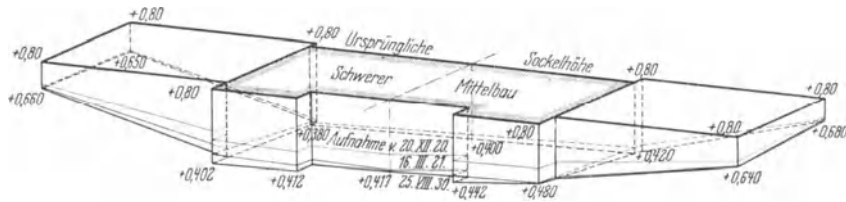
Setzungen des Doppelwohnhauses Priok.
